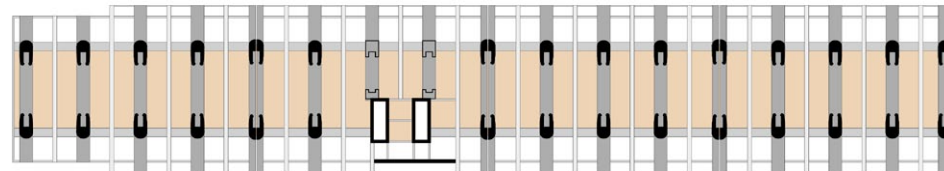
Ámbito de aplicación de cargas en la planta inferior del suelo técnico.
